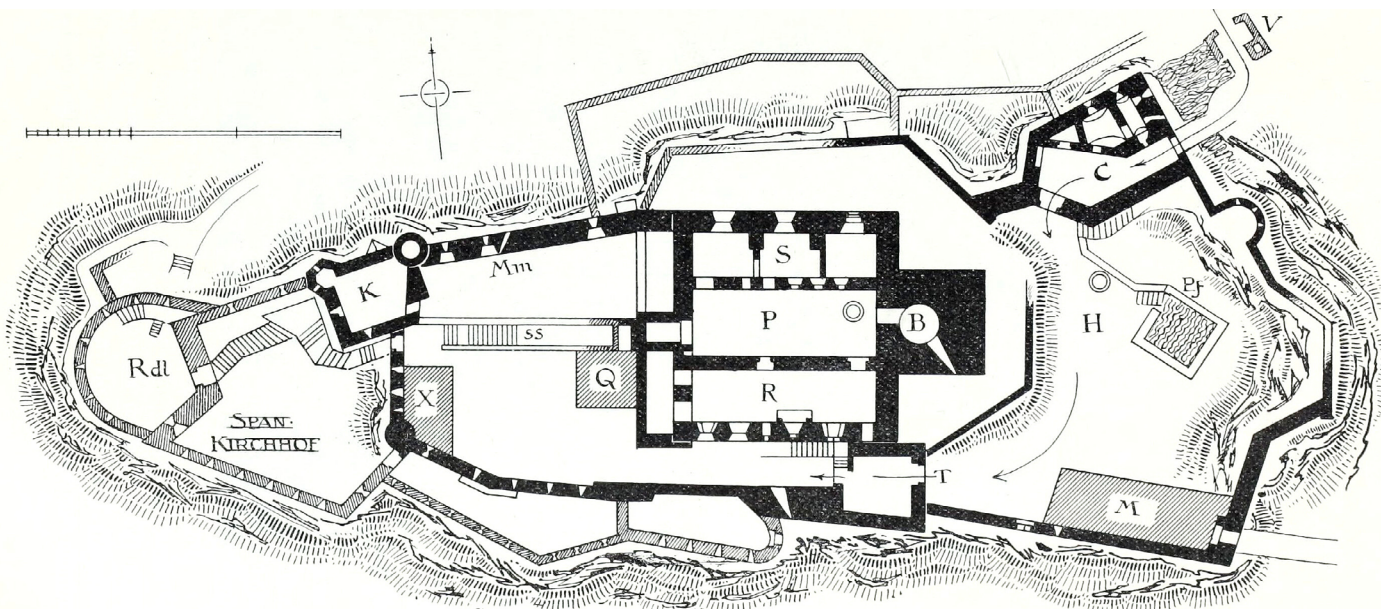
Caub. Burg Gutenfels. Grundriss.
